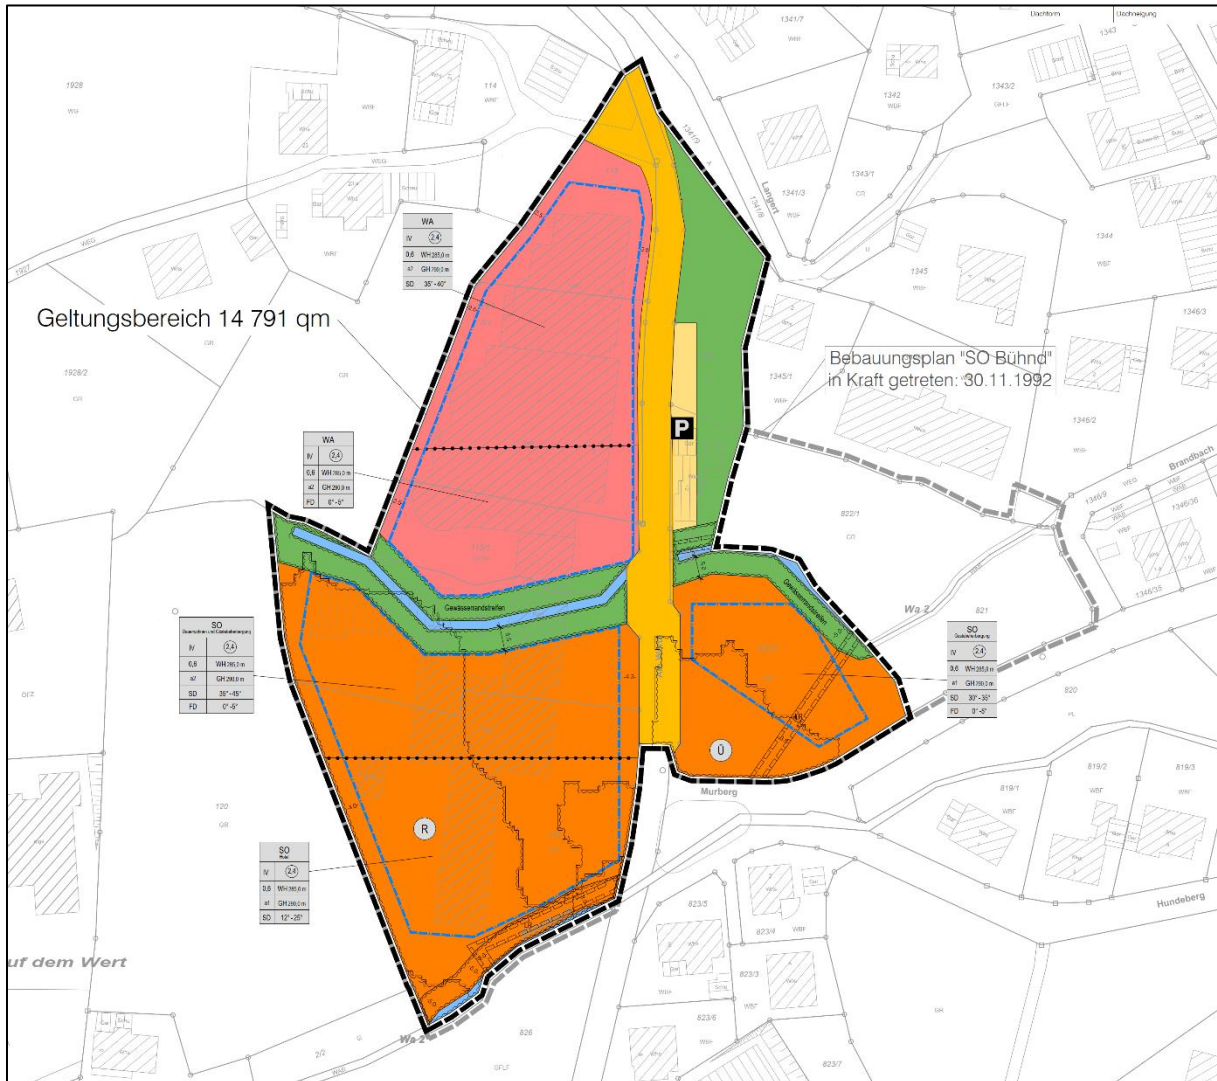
Bebauungsplan Neuaufstellung „Bühnd“ vom 18.01.2022 (Auszug); Quelle: Gemeinde Sasbachwalden
